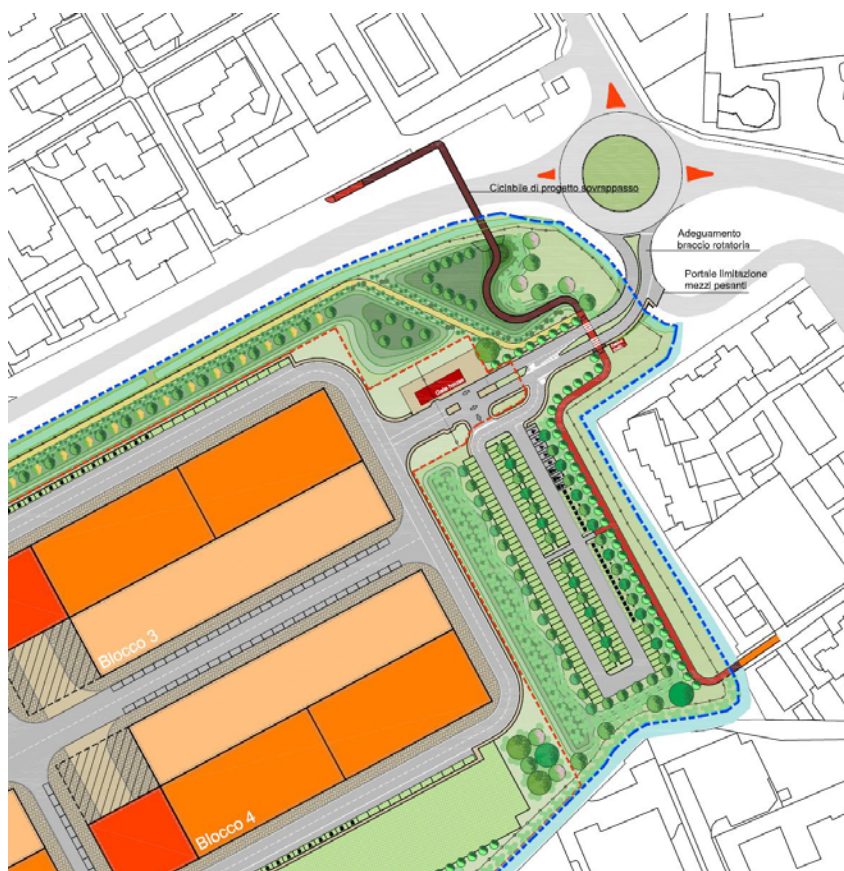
Planimetria di progetto, accesso Est e nuovo sovrappasso ciclopedonale
